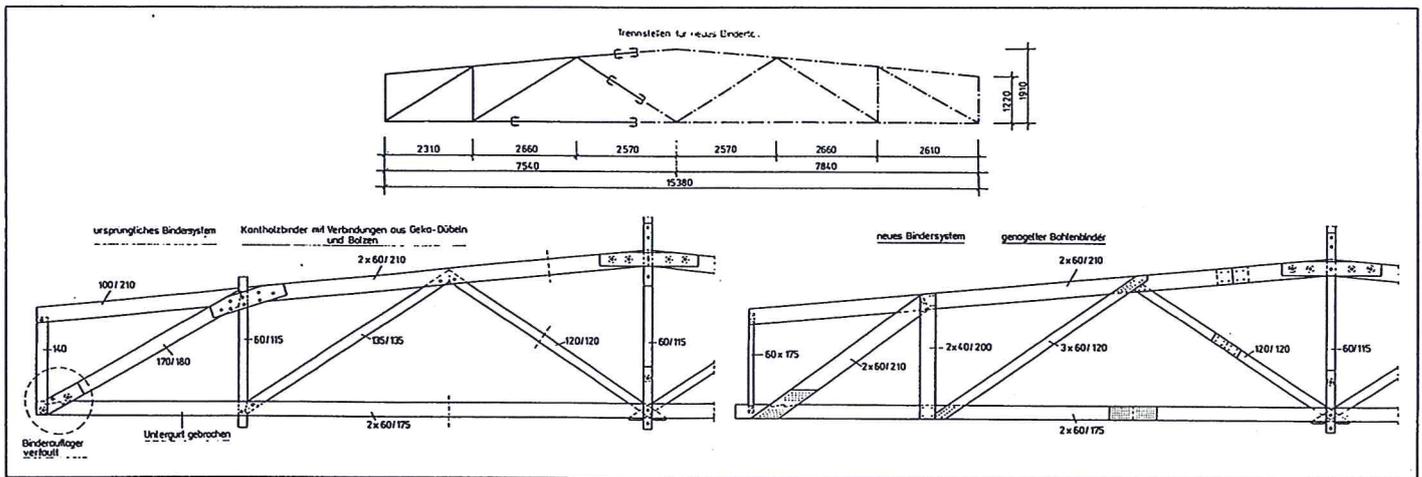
Bauschäden an einem Fachwerkbinder einer Produktionshalle 16 m × 60 m infolge eingemauerter Binderauflager, Baujahr 1925
